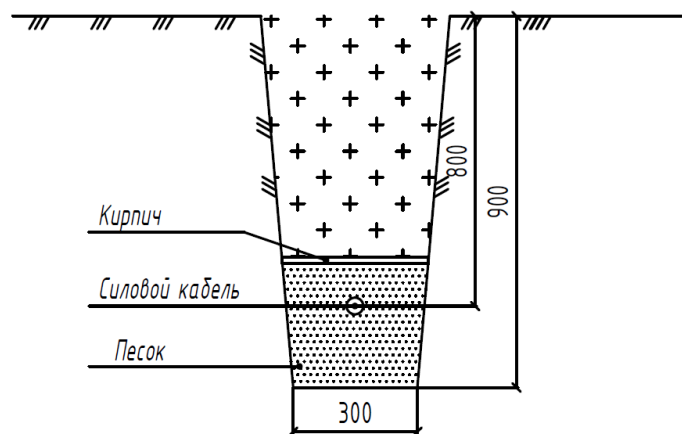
Внешний вид кабельной траншеи типа Т-1 для прокладки одного кабеля
